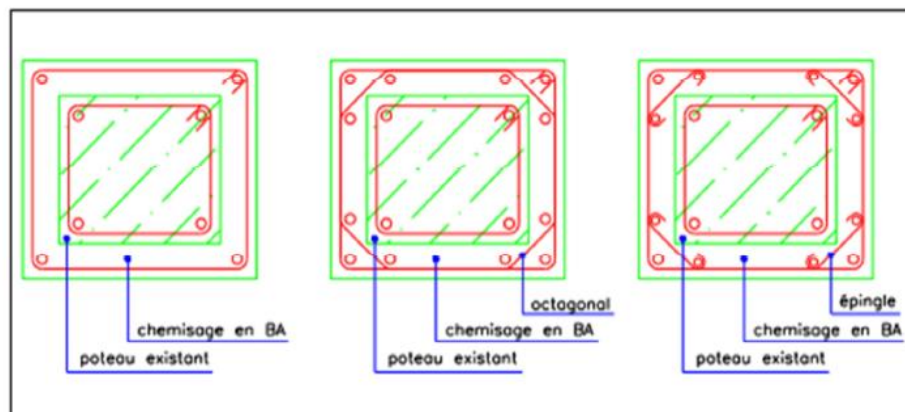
Dispositions possibles d'armatures sur poteau [1].
